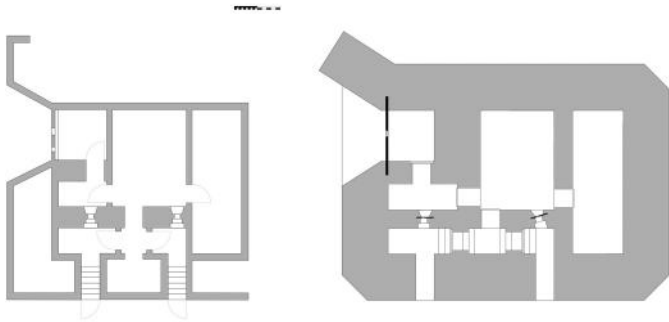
Grundriss und Regelbau 503 (Patrice Wijnands)
